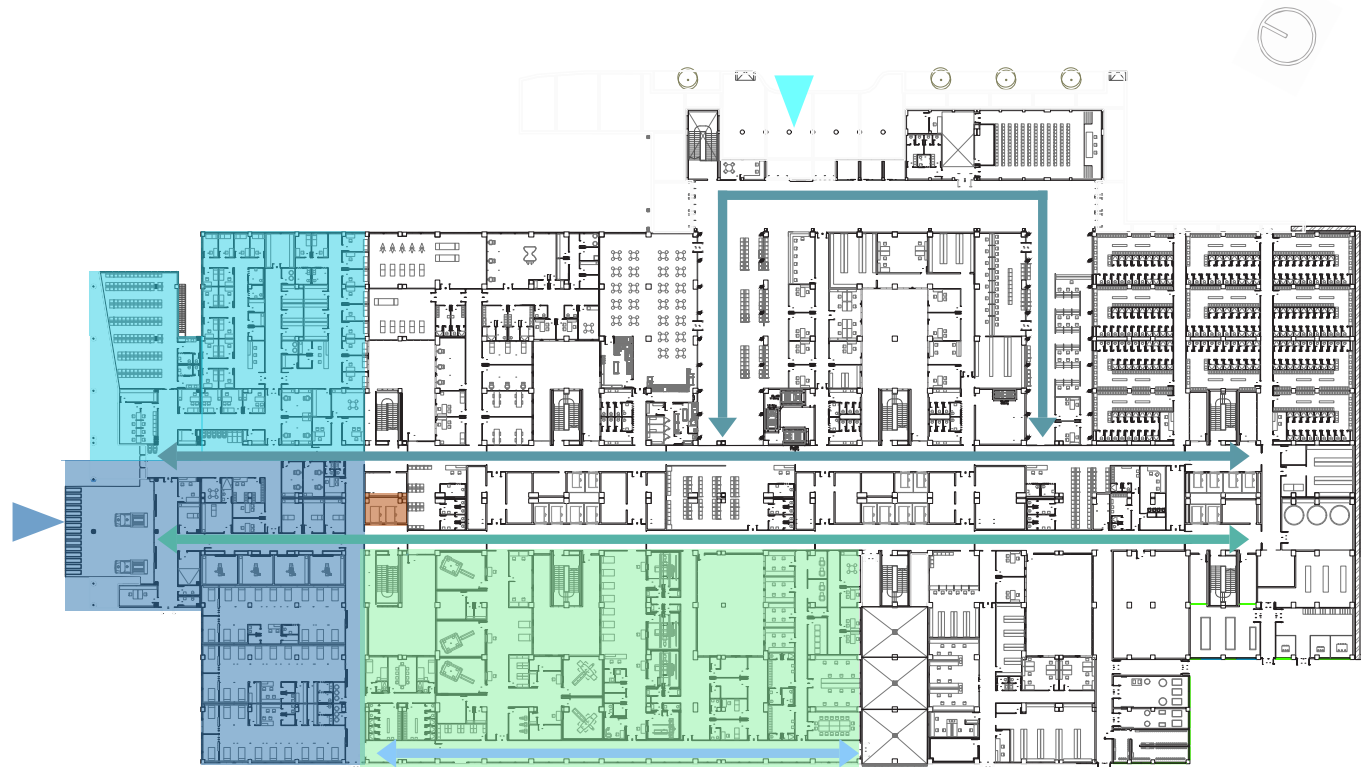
| Plano Arquitectónico (Autores,2020).
